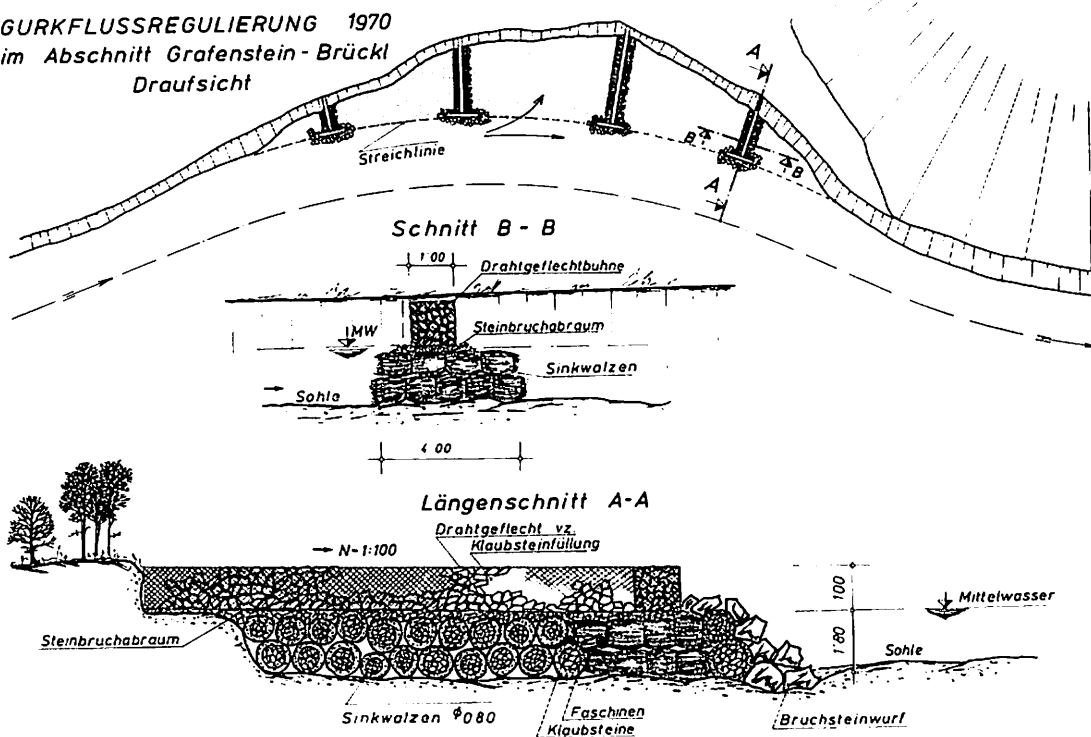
Gurk川の溪岸崩壊を含む近自然河川改修区間の平面形状及び横断面
